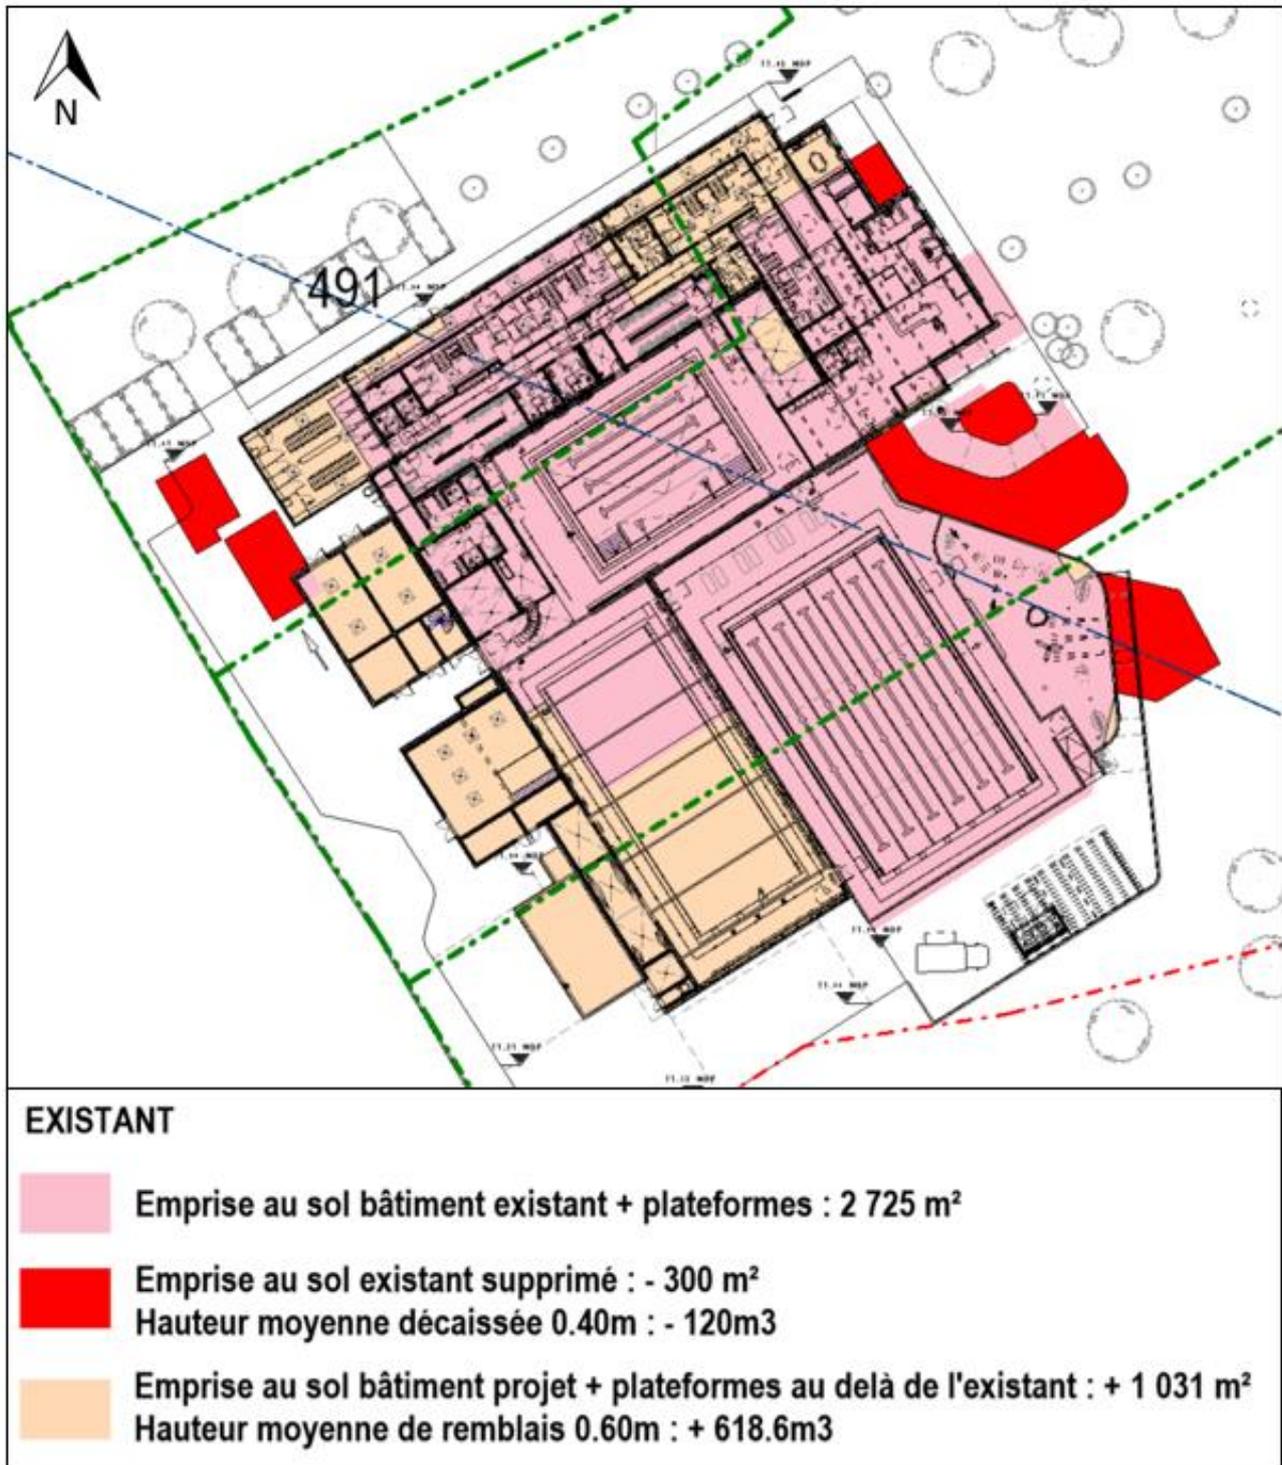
Plan des cubatures de terrassement au droit du bâtiment du projet
